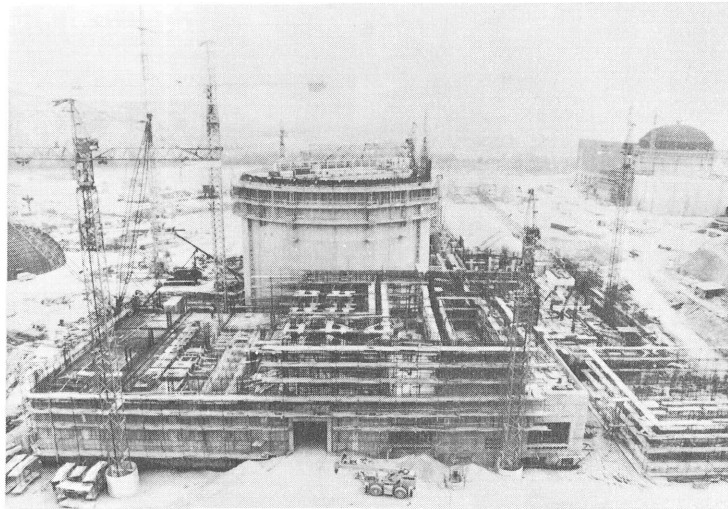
Armadura de las paredes y contrafuerte del edificio de contención. Pueden verse las primeras placas de apoyo de los tendones horizontales, colocadas en un contrafuerte.
